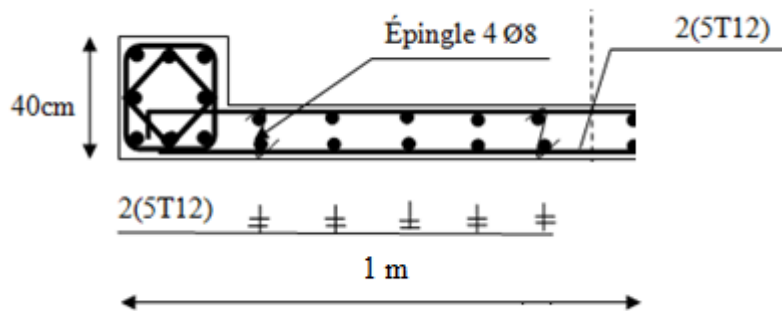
Schéma de ferrailage du mur voile (Type 2).
